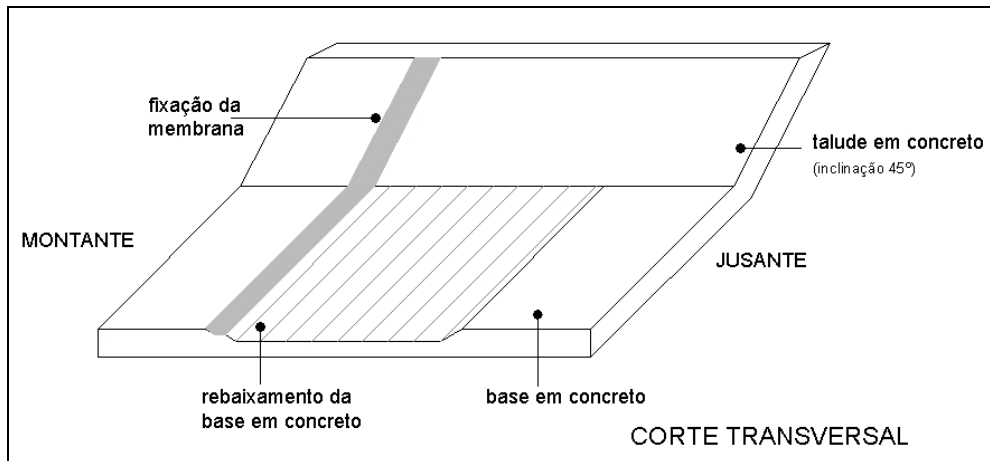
Corte transversal da estrutura da seção para instalação de barragem flexível.
